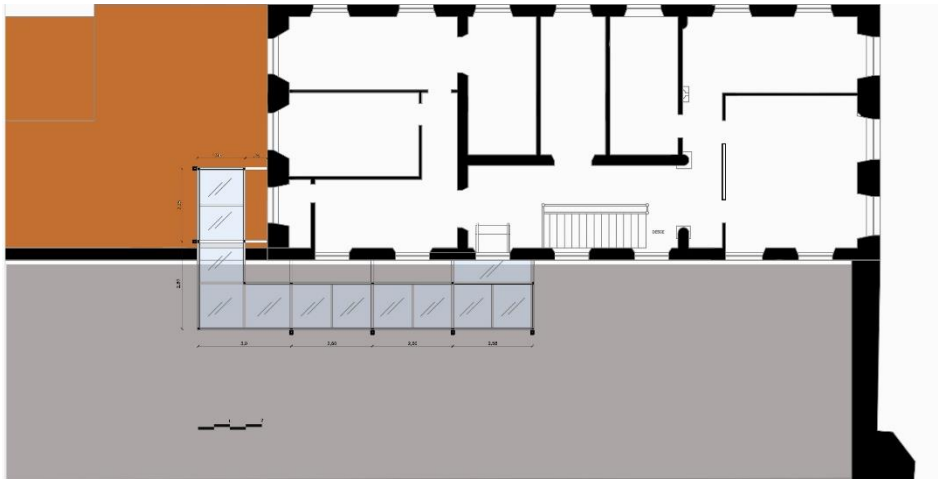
Planta Baixa Passarela- Mirante. Fonte: Autoral
